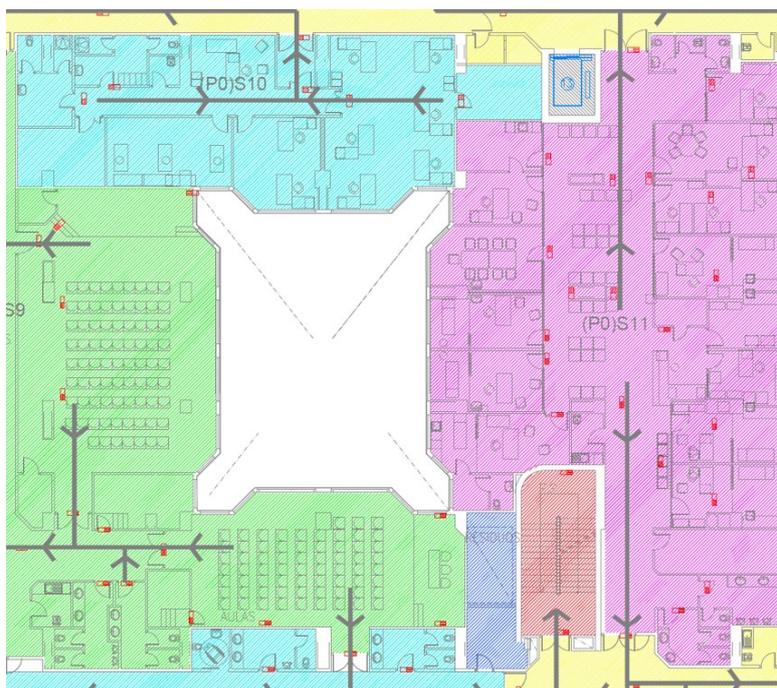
Plano de situación del Servicio de Medicina Preventiva. Planta 0
